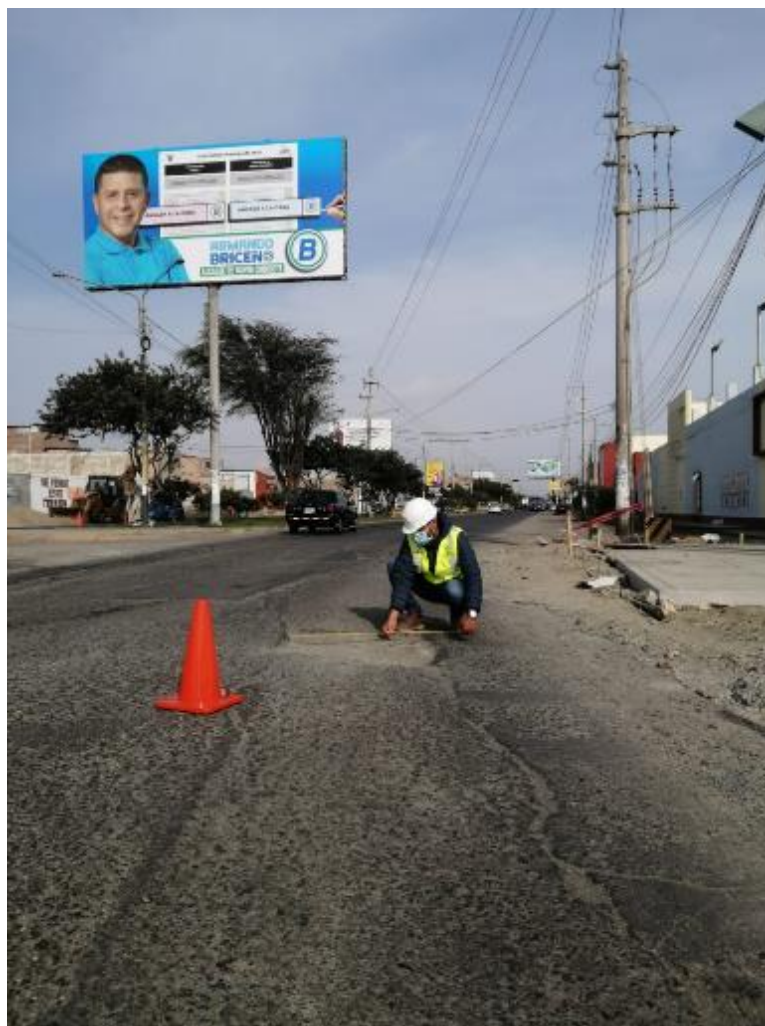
Bacheo, fisura de borde y fisura longitudinal en Av. Pacífico
